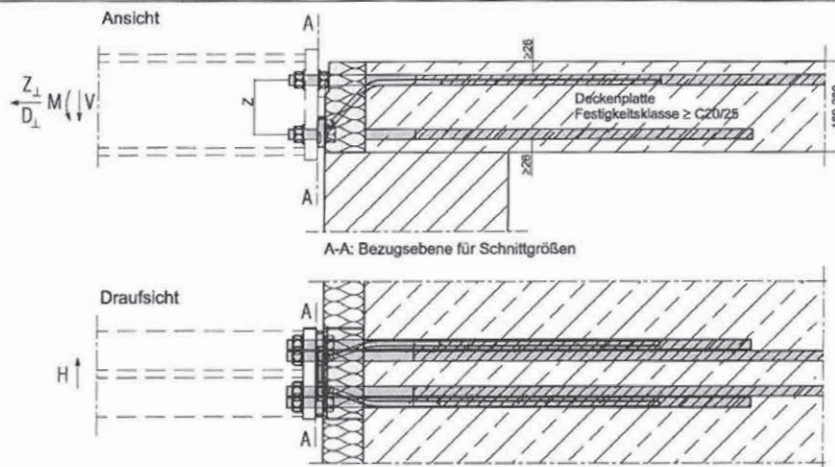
und 60: Schöck Isokorb® Typ KS20 V12, Schnittgrößendefinition
